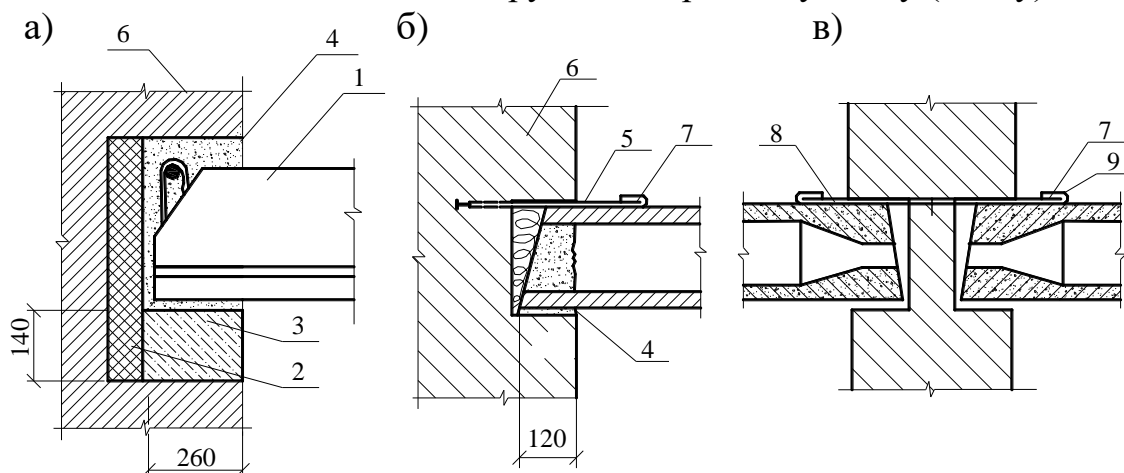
Опорні вузли залізобетонних балок та плит перекриття:
